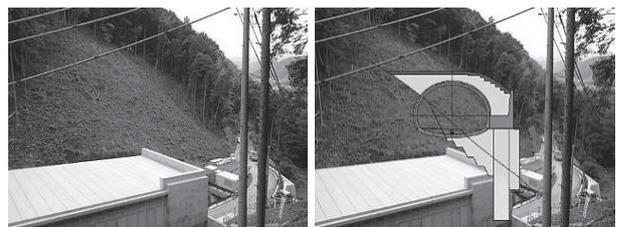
起点側坑口部(左：着工前 右：施工イメージ)
